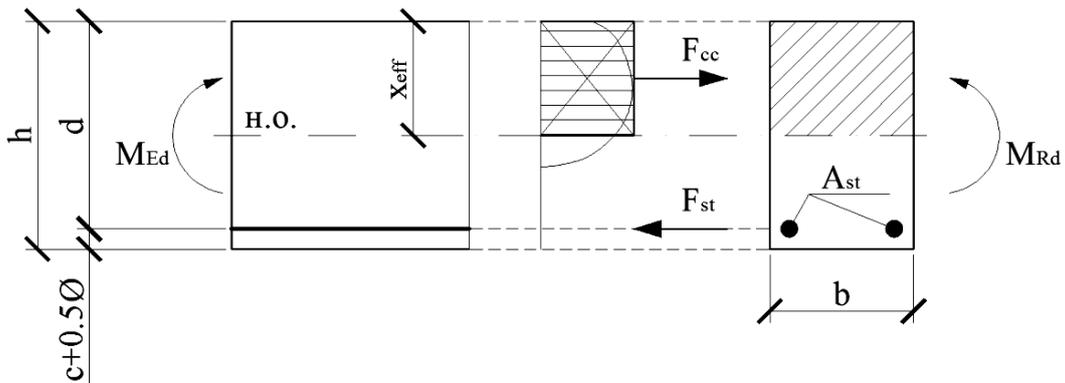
Расчетное сечение балки с одиночным армированием
